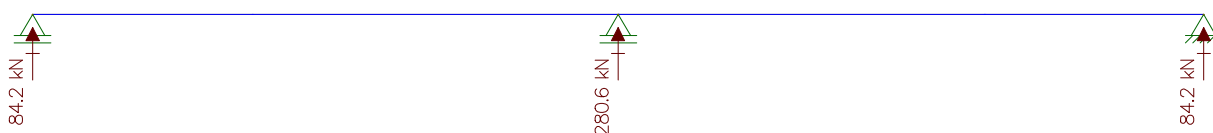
Reações de Apoio - Viga 9 (Cobertura)
